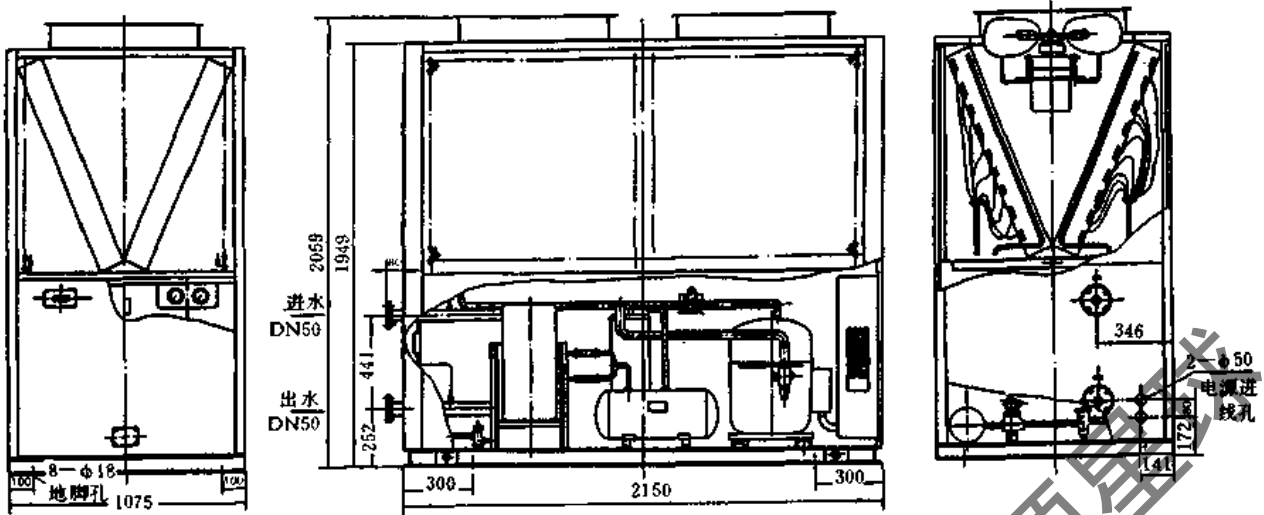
FLS-50、FLSP-50 型机组外形尺寸
